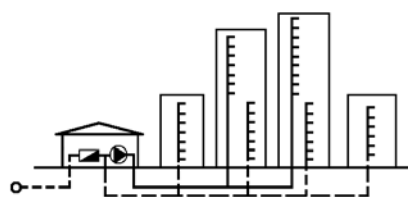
Схема параллельного зонирования системы водоснабжения микрорайона с разноэтажной застройкой: 1 – ввод; 2 – здание ЦТП; 3 и 4 – сети верхней и нижней зон
